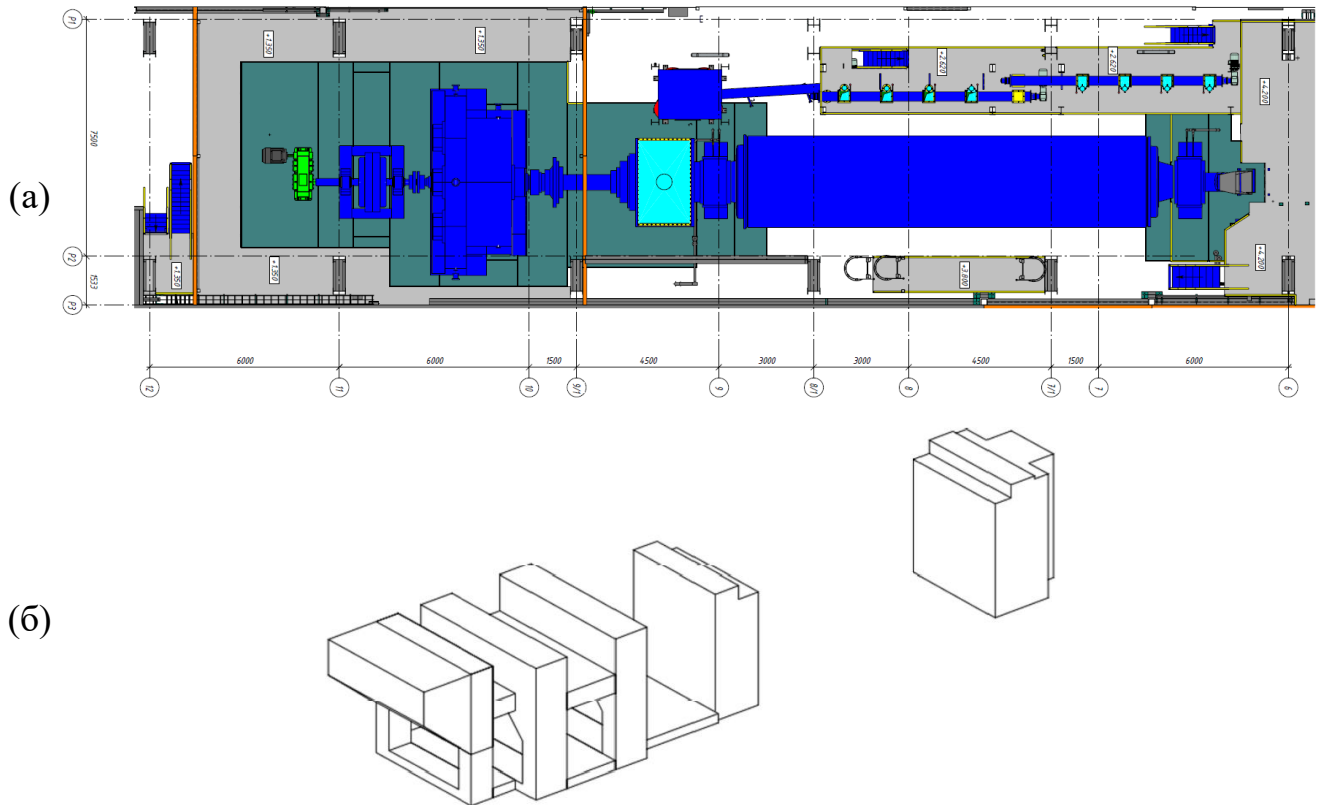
План (а) размещения трубной мельницы в цехе (мельница выделена синим цветом, фундаменты мельницы – зеленым) и аксонометрическая схема фундаментов трубной мельницы (б)
